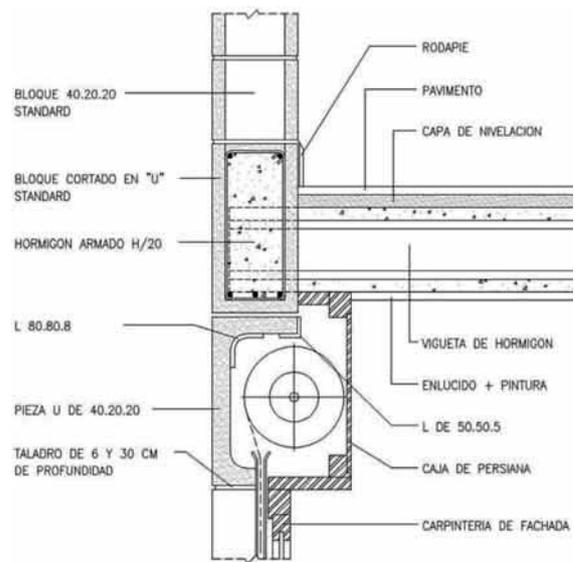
Detalle de caja de persiana en muro de 1 hoja de bloque hueco de carga.
